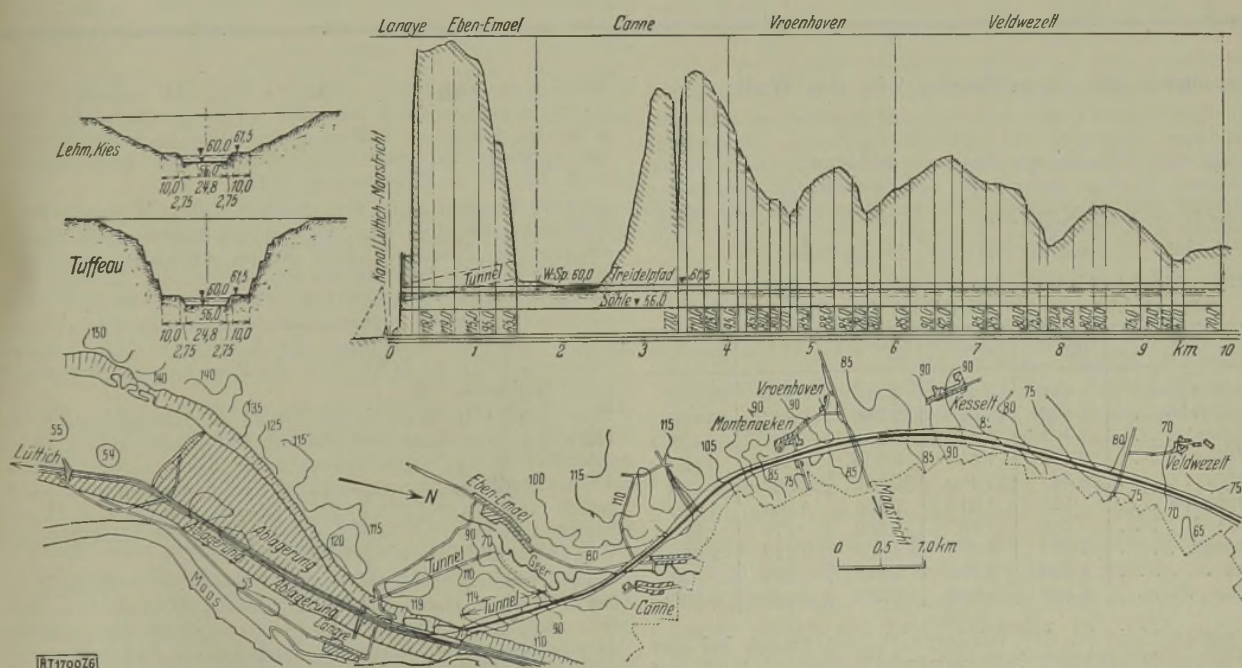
Lageplan mit Längsprofil und Querschnitten zum Bau des Kanals Lüttich—Antwerpen
